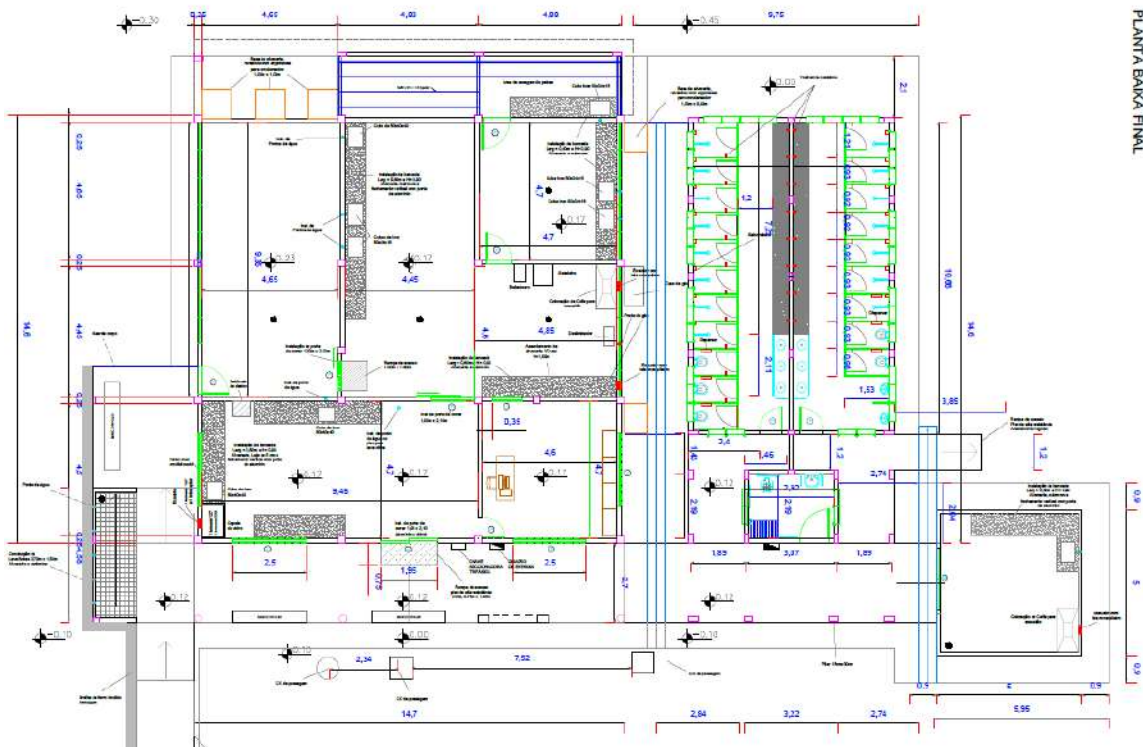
Planta arquitetônica final - 04_ARQ_AGROINDÚSTRIA_FINAL
